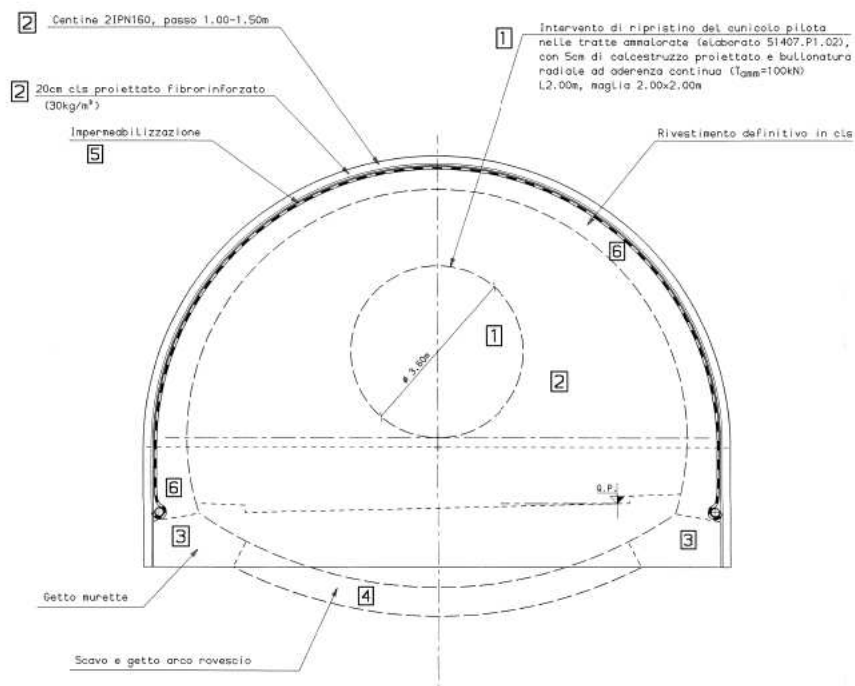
PE GEODATA 1996 – Galleria Guinza - Sezioni Tipo C2 – Sezione di scavo
